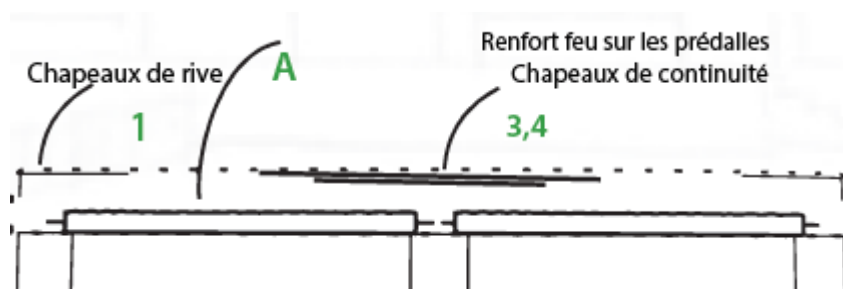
ACIERS AJOUTES SUR CHANTIER
